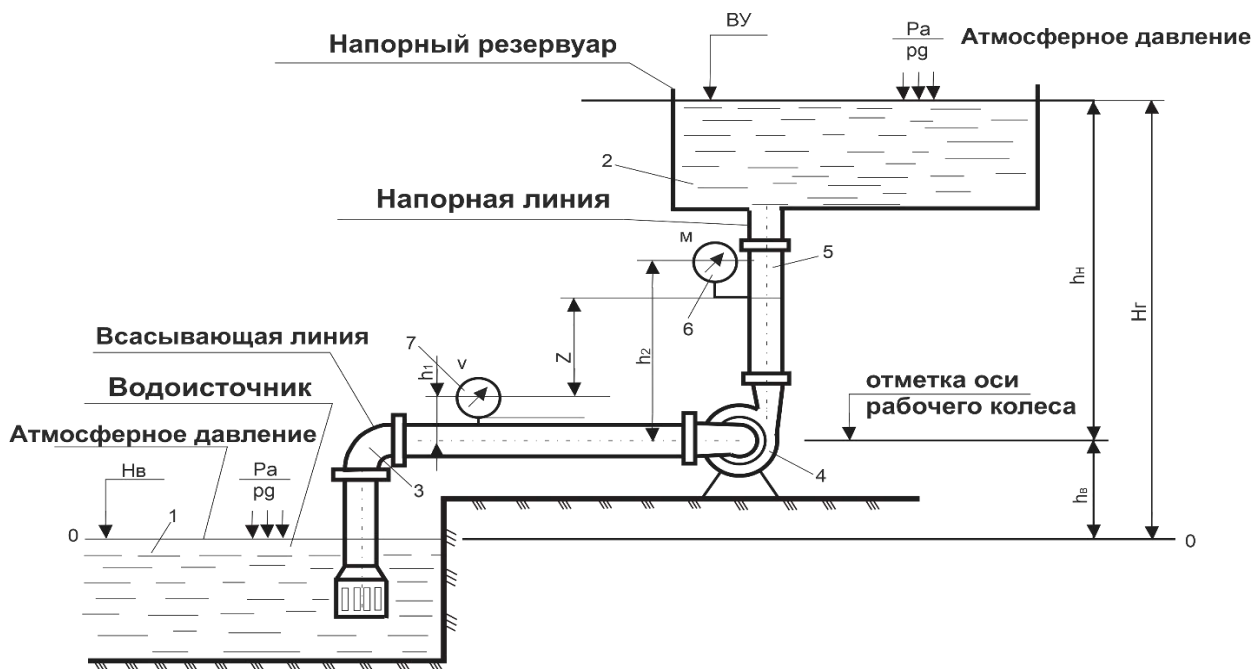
Монтажная схема центробежного насосного агрегата с положительной высотой всасывания и подачей в напорный резервуар
